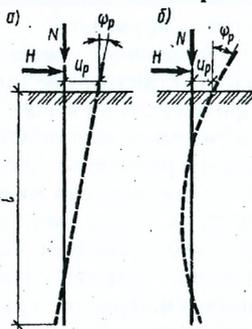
Схемы работы горизонтально нагруженных свай
